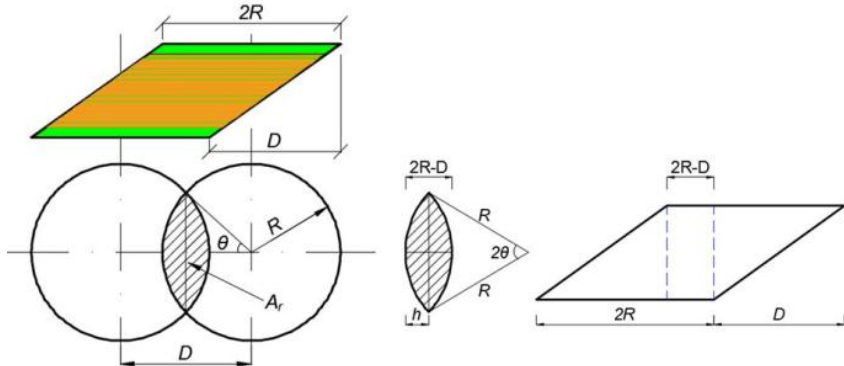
Совпадающая площадь сечения верха и низа круглой в плане СРМОС
